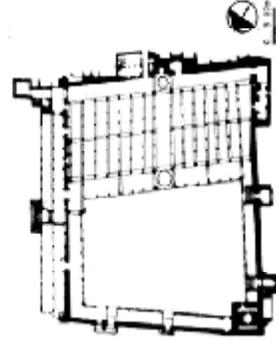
مسقط أفقي لجامع القيروان، عن: Hillenbrand, R., Islamic Architecture, PL 2, 143
